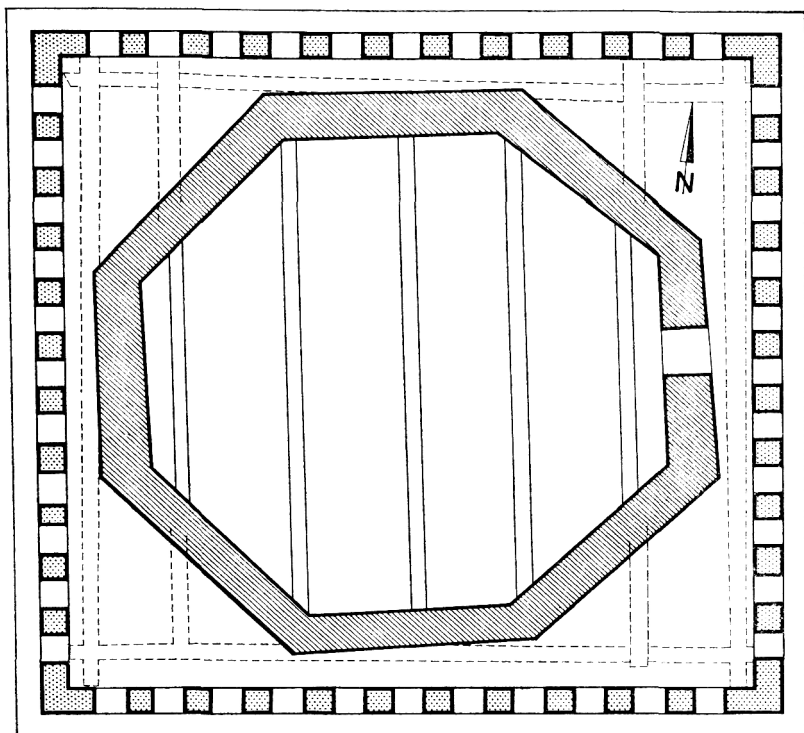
Plan du 6e étage. Echelle 1 : 100
